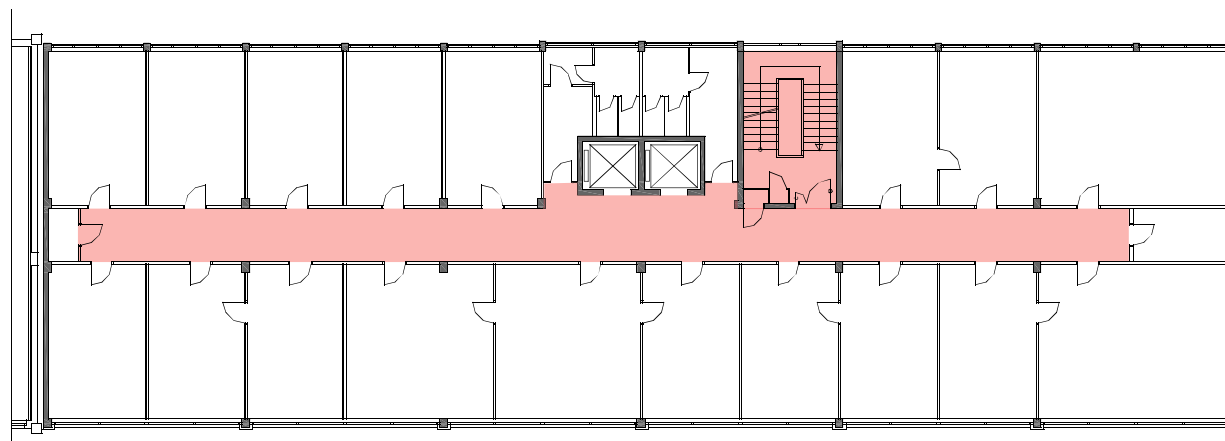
Grundriss Regelgeschoss Schering AG M 085
